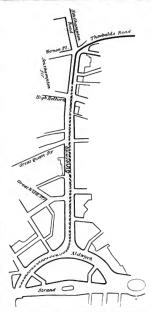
Lageplan der Unterpflaster-Straßenbahn Holborn-Strand.
